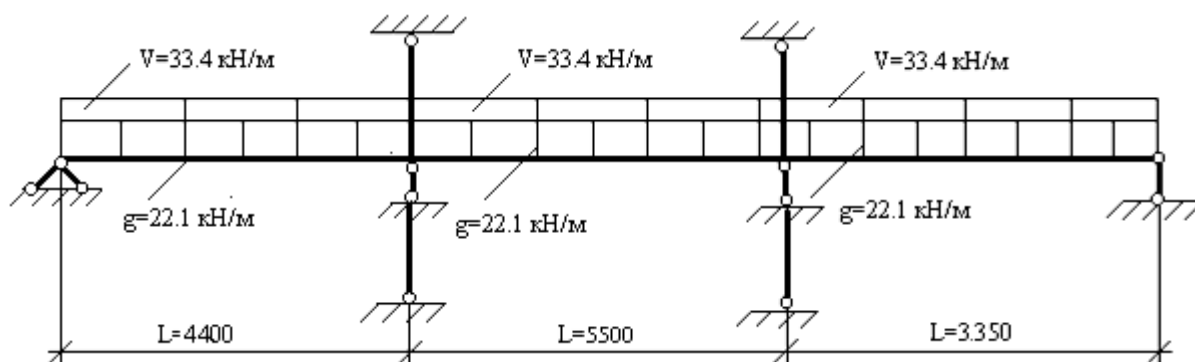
Розрахункова схема ригеля перекриття
